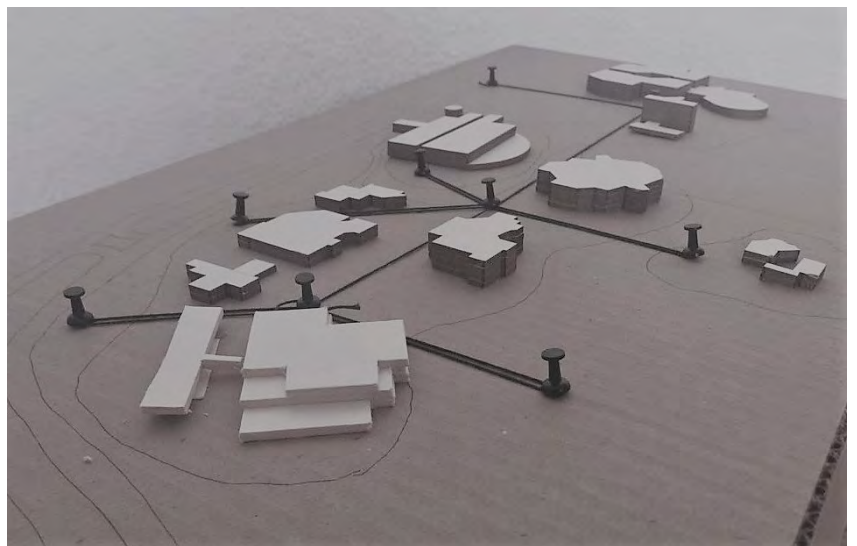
Maqueta de conjunto, vista Sur-Norte en perspectiva del edificio.
